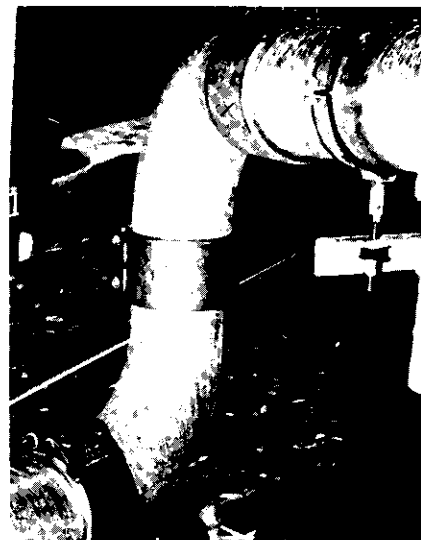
Detalhe de abraçadeira tipo flexível, instalada em curvas de 90°
